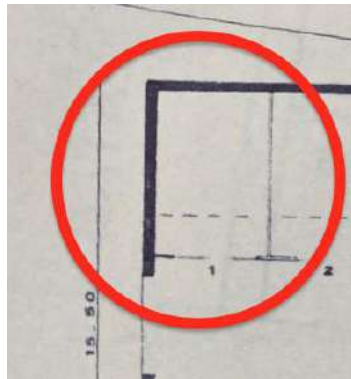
Grafico planimetrico ex C. E. prot. n. 2599/88 (cfr. All. 7c3)
